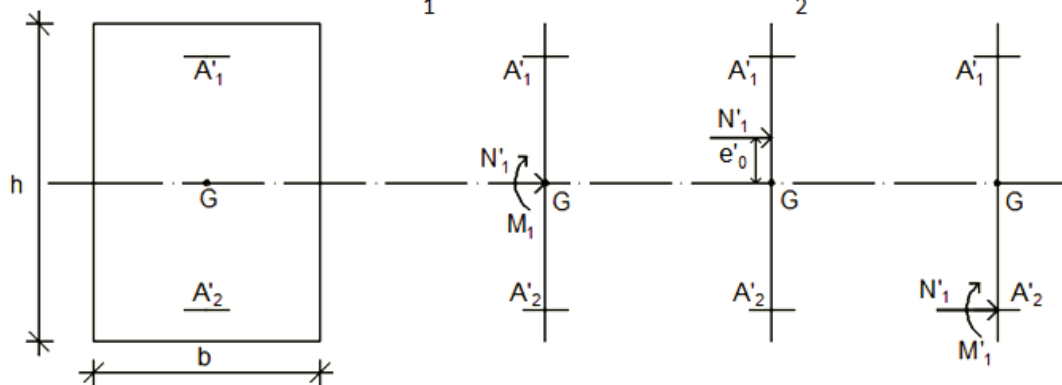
Position de N'_1 , M'_1 et M_1 sur la section transversale.
